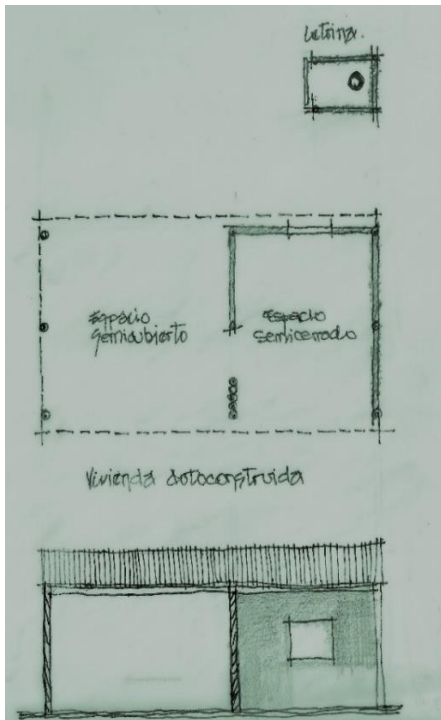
Viviendas autoconstruida construidas por el usuario
